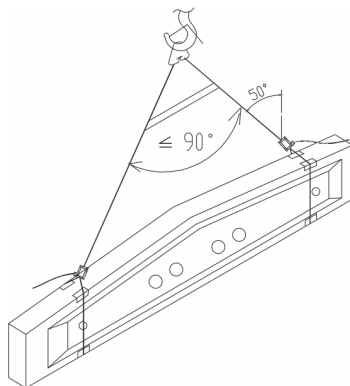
Схема строповки стропильной балки СБ-1 при разгрузке
